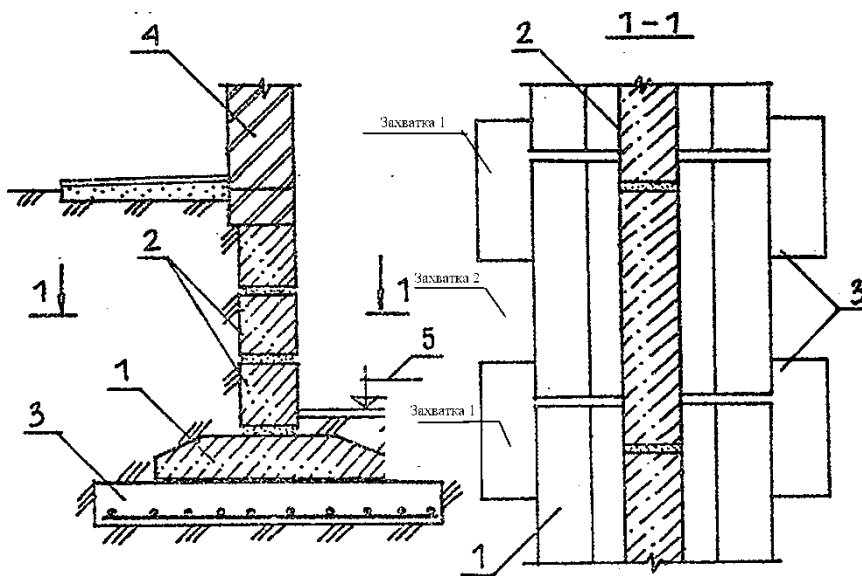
Збільшення площі фундаменту який спирається з обтисканням конструкції фундаменту і ґрунту основи.
